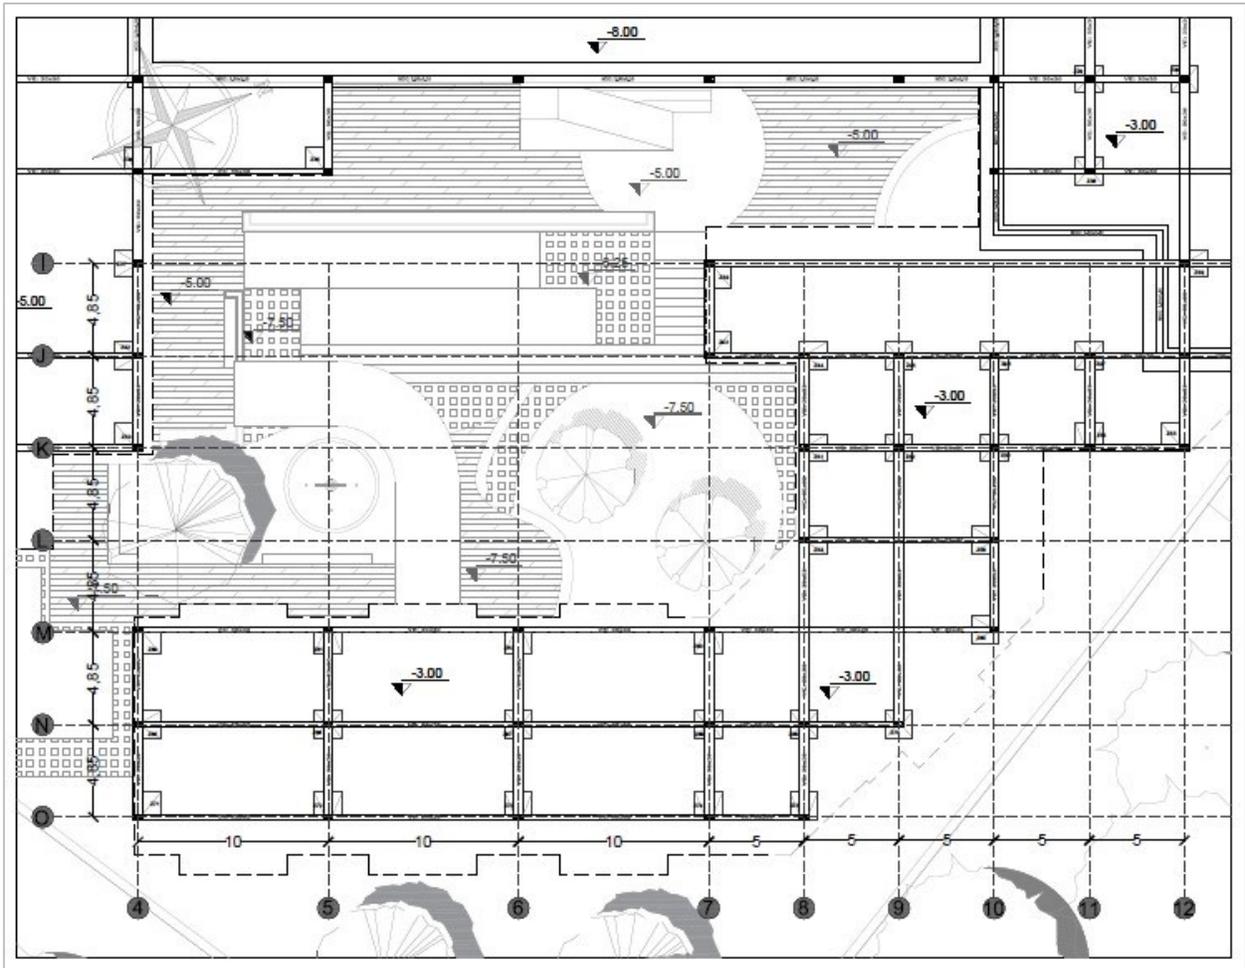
Cimentación Edificio 3 (Rubiano, 2020)
